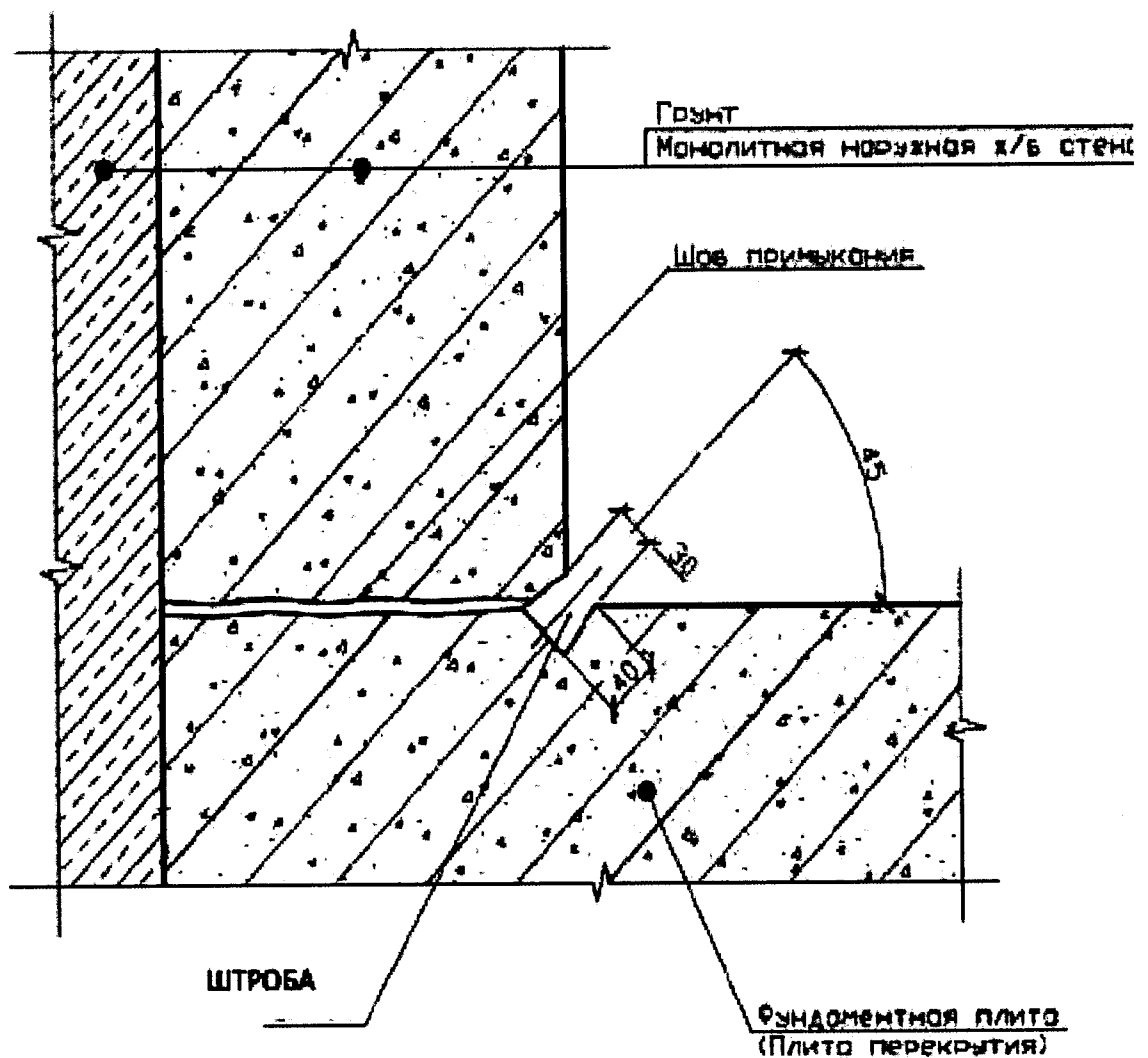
Герметизация конструктивных швов примыкания: «фундаментная плита-наружная стена», «плита перекрытия-наружная стена». Расшивка шва
